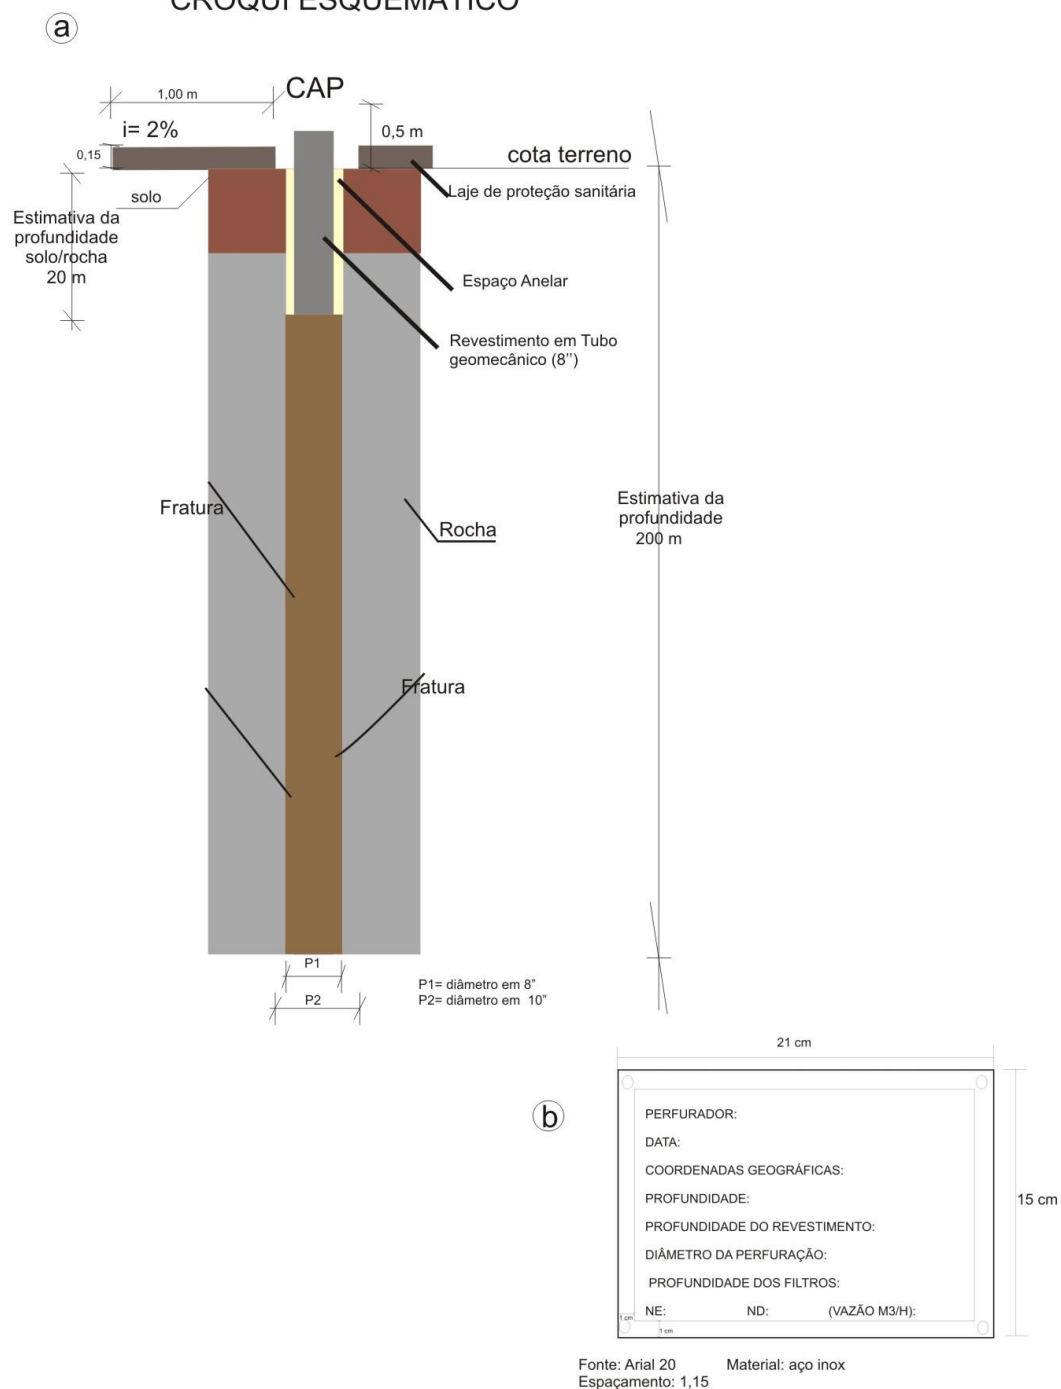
Croqui esquemático para construção do poço e modelo de placa de poço
